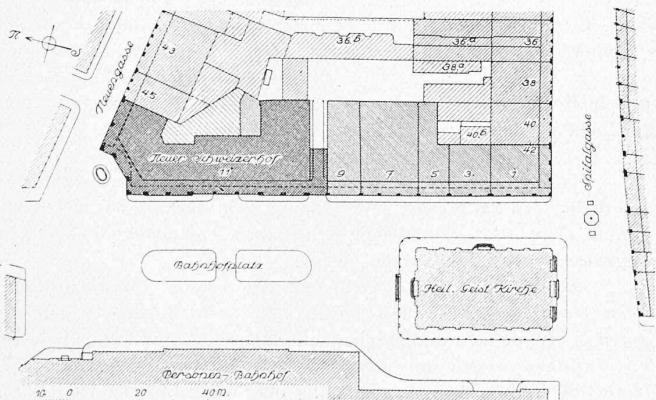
Lageplan des neuen Hotel Schweizerhof. — 1:2000.
